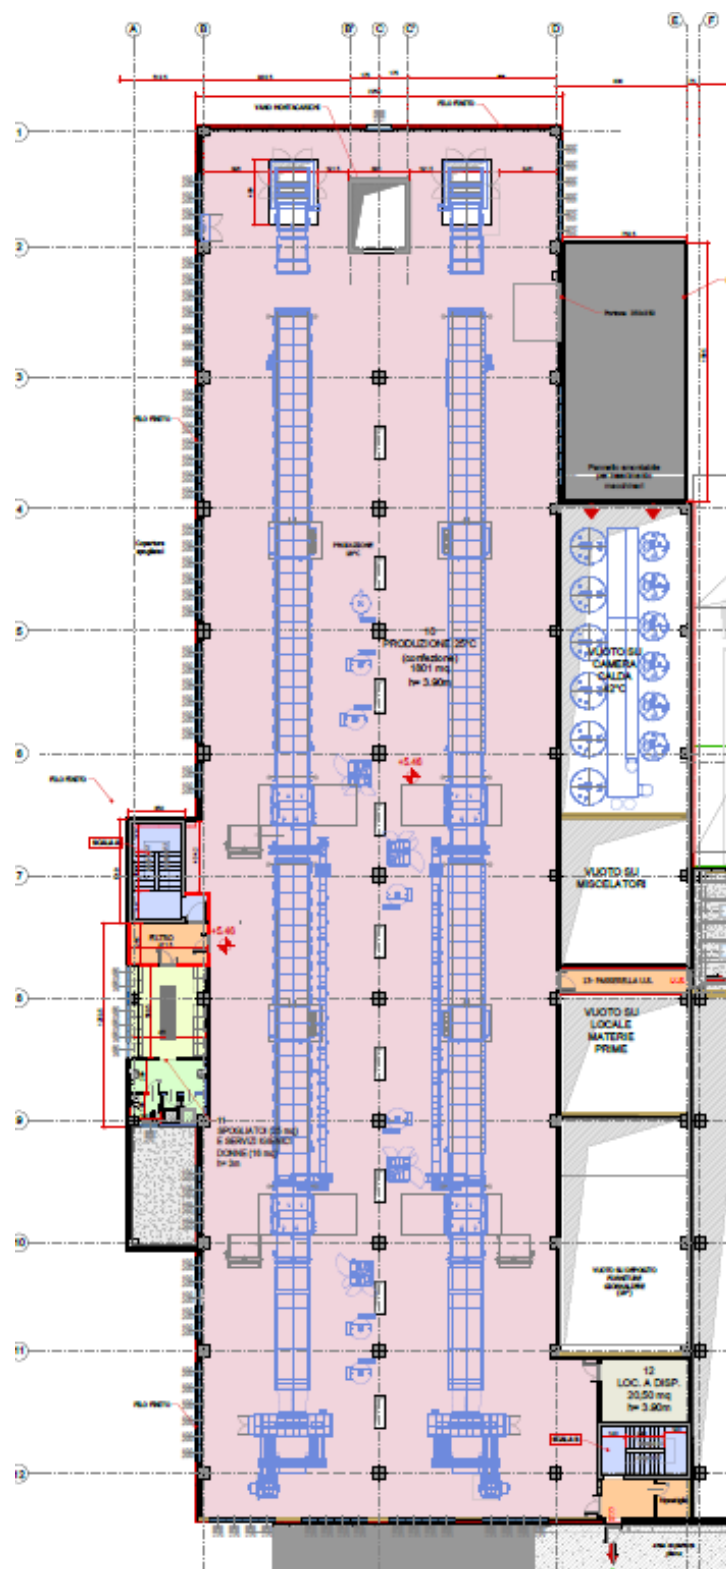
Planimetria architettonica piano P0 - Fabbricato Ex. Piemonte
